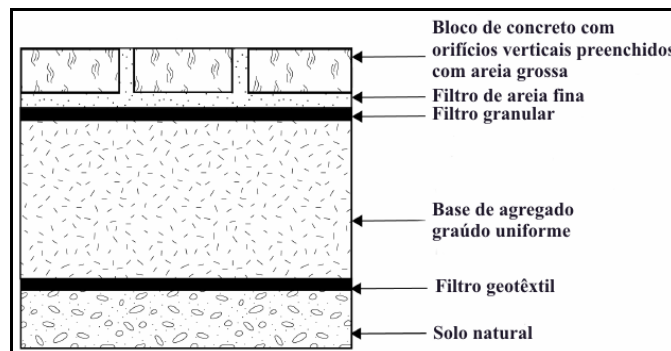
Perfil vertical de pavimento permeável com armazenagem (traduzido – NJDEP, 2004).
